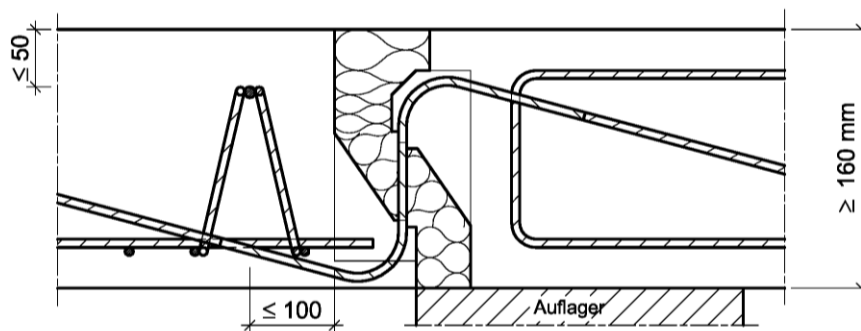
Beispiel Schöck Isokorb® Typ V mit Vertikalbewehrung nach Abschn. 3.1.5
